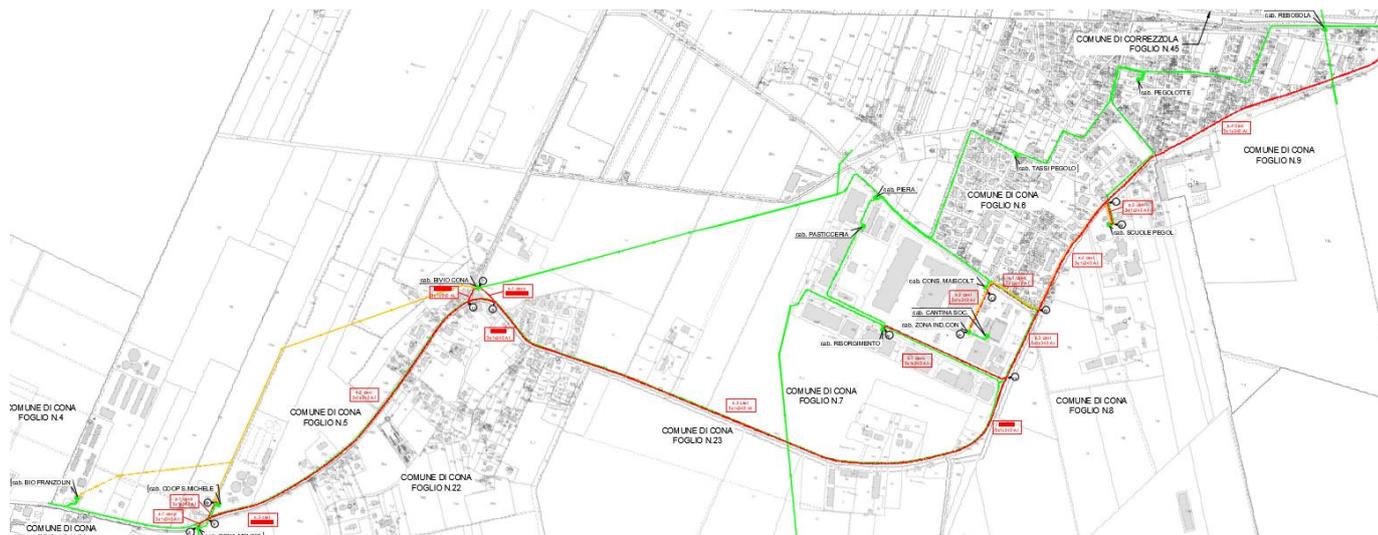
Tracciato elettrodotto di progetto (Fonte: Relazione di progetto)
